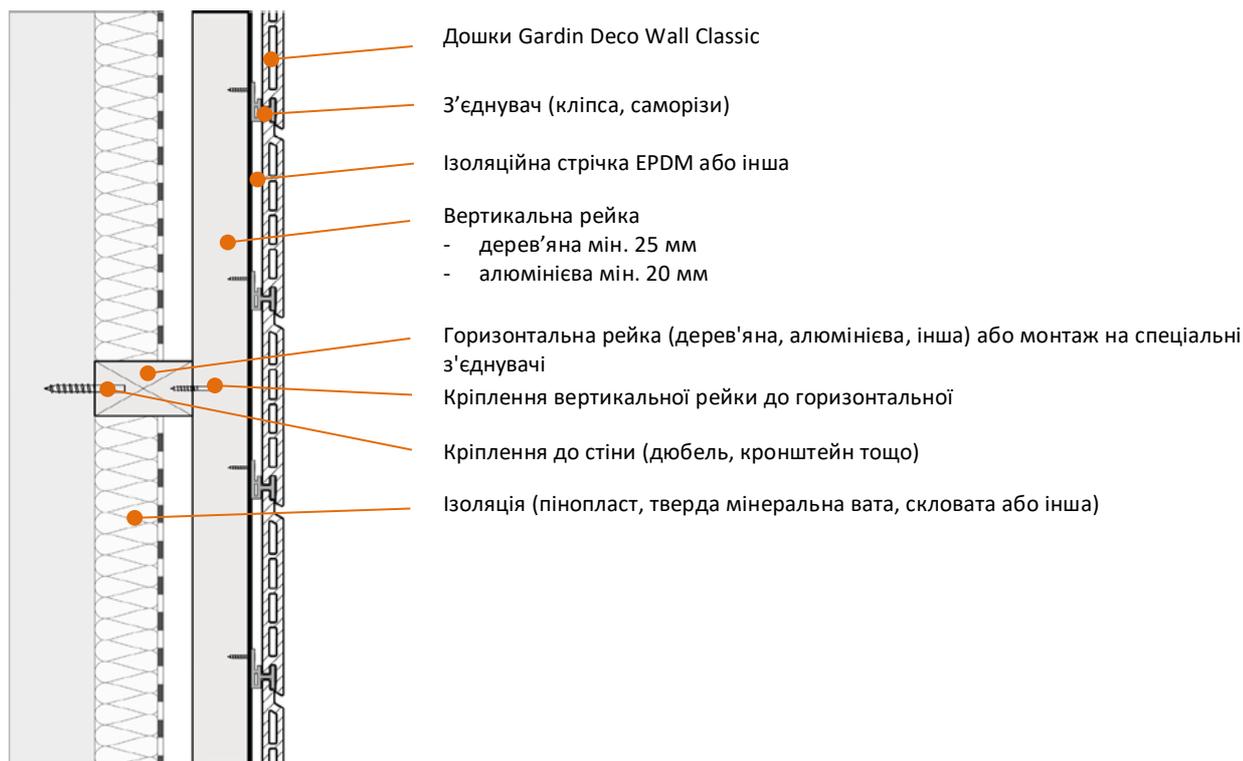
Схематичний переріз вентиляованого фасаду з прикладом облицювання Gardin Deco Wall Classic
